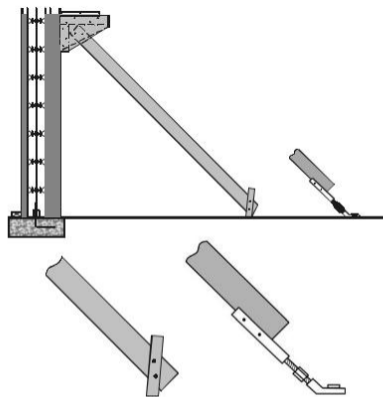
Элементы ригельных, крепления подкосов на грунтовой подставке и до железобетонному перекрытию
